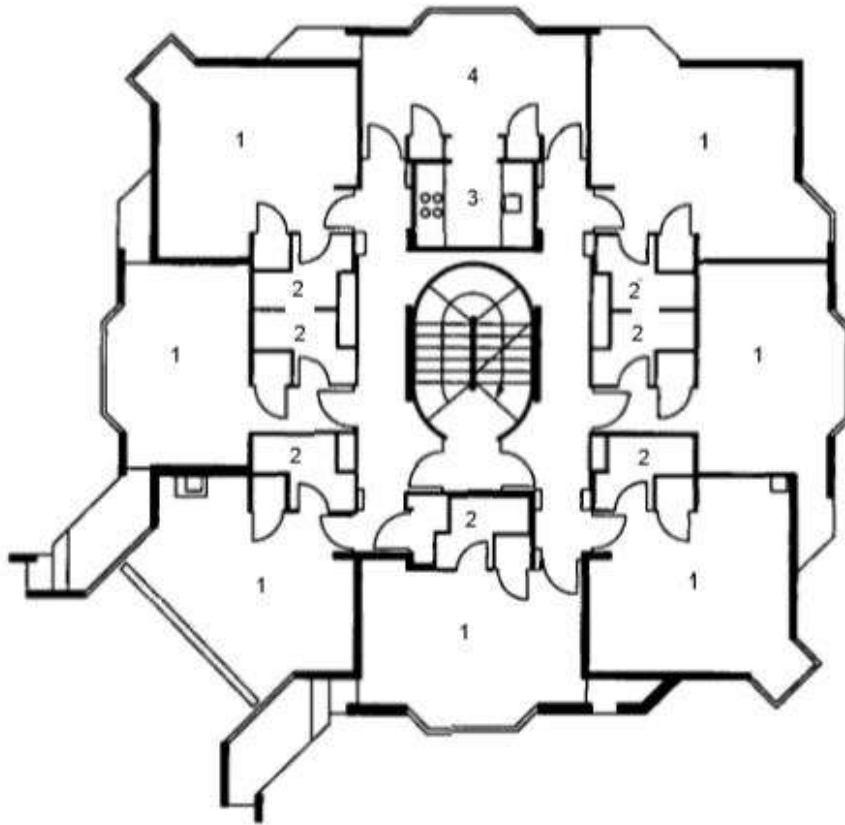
Planta do Pavimento Tipo. Balliol College, Reino Unido.
